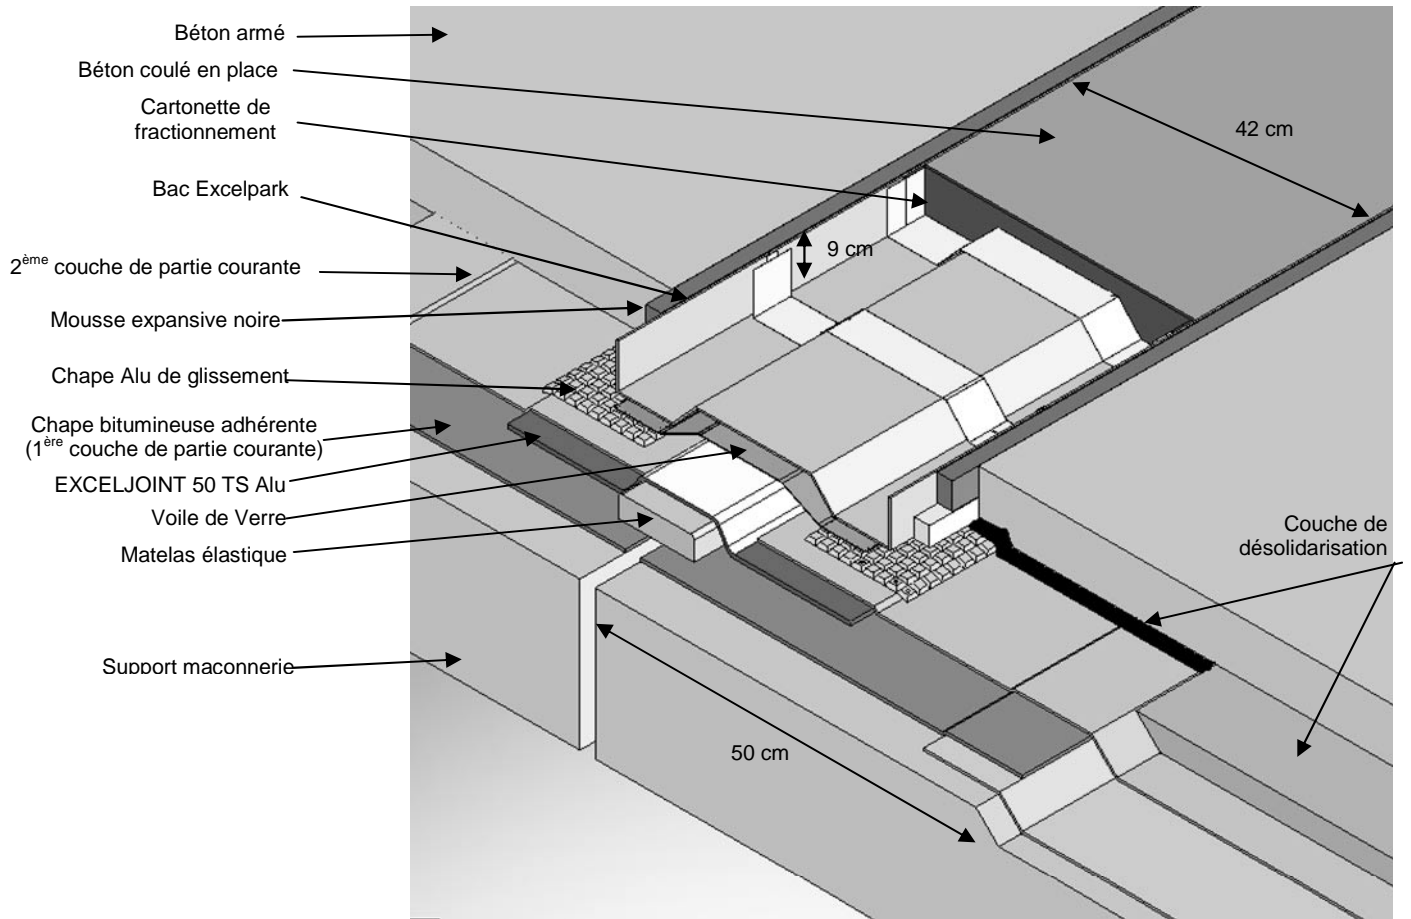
EXCELPARK 1 Béton : schéma de principe sur support maçonnerie
